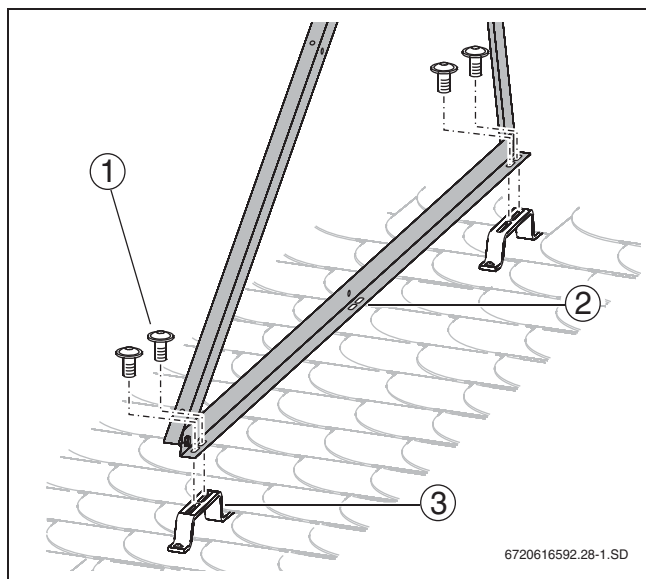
Крепление специальными кровельными крюками (здесь: на покрытие шифером/ гонтом)
